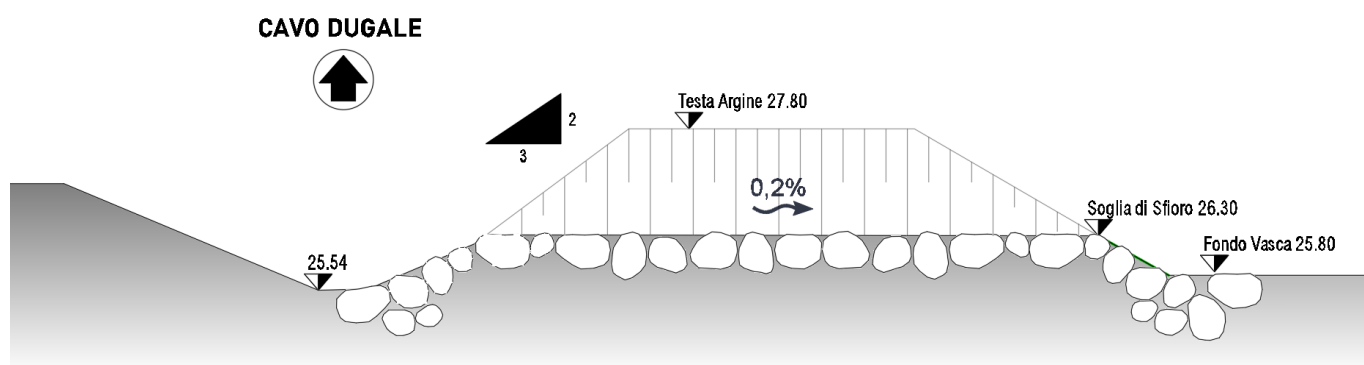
Manufatto di ingresso al bacino di laminazione: sezione trasversale – Cavo Dugale
